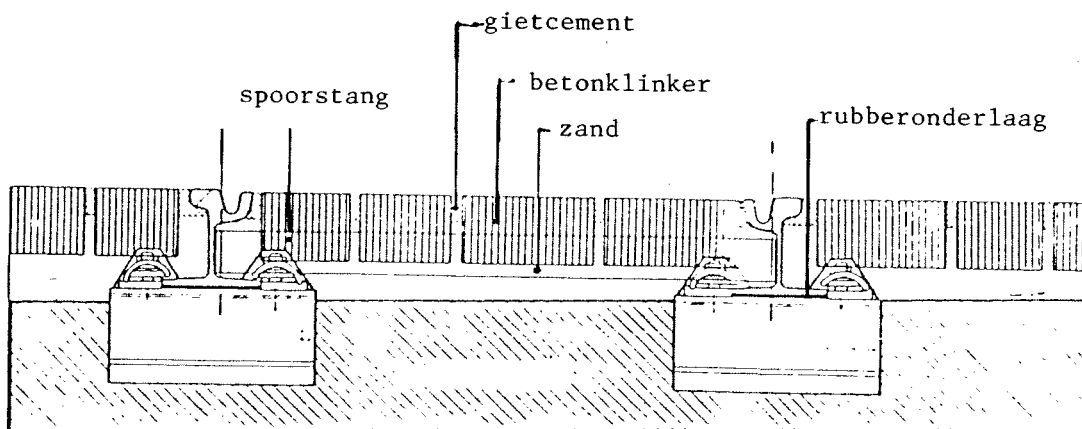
Groefrail in betonconstructie zoals deze is toegepast in Rotterdam.
